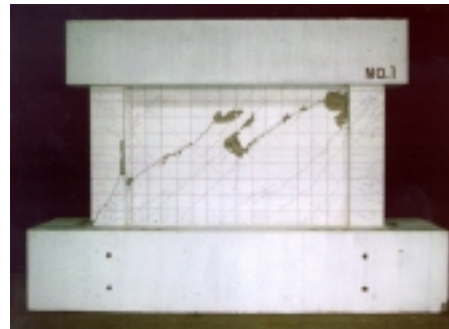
試験後のNo.1試験体のひび割れ状況 Crack of No.1 Specimen after Loading
